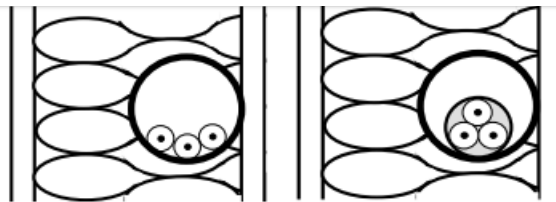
Figura B Tubos en canalizaciones empotradas en paredes térmicamente aislantes
